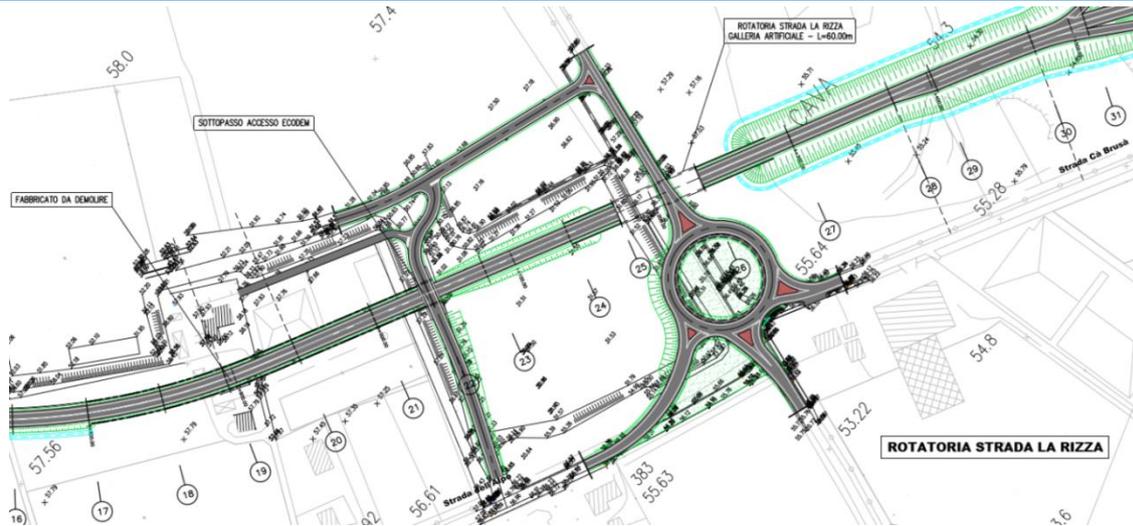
Rotatoria strada La Rizza- Planimetria
